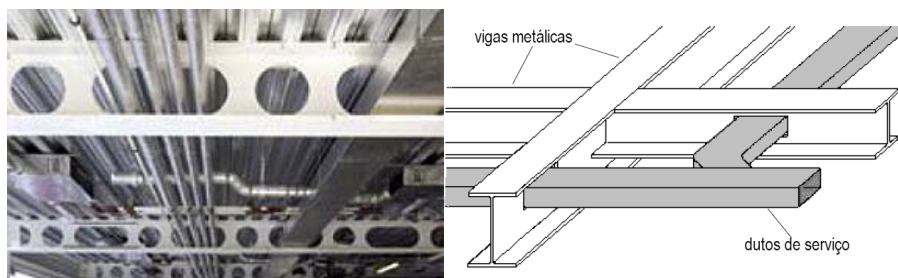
Passagens de tubulações em aberturas de vigas de aço [24]
